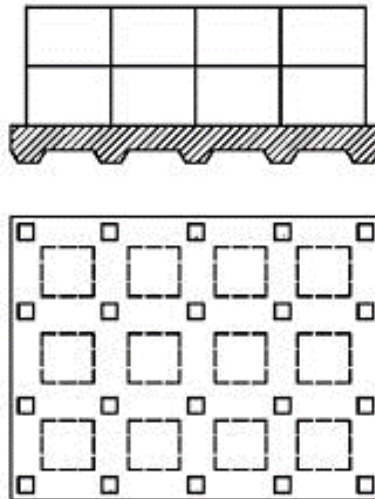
, tipos de platea de cimentación, fuente libro de diseño estructural.
